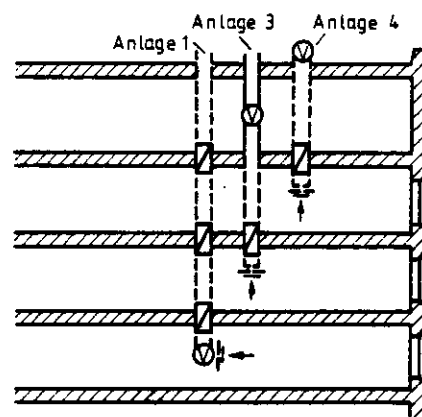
Entlüftungsanlagen mit getrennten Hauptleitungen und Absperrvorrichtungen für Lüftungsanlagen entsprechend DIN 18017 Teil 3
